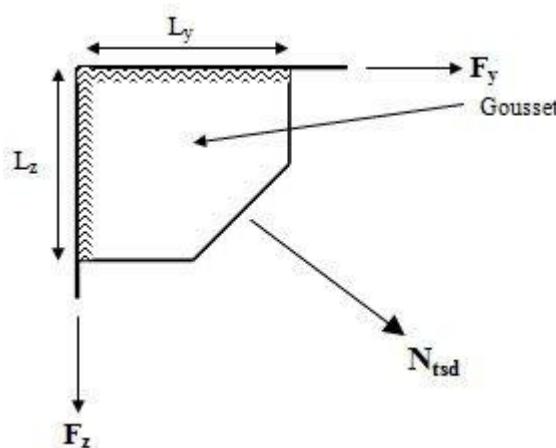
Assemblage gousset nœud du portique par cordon de soudure.
